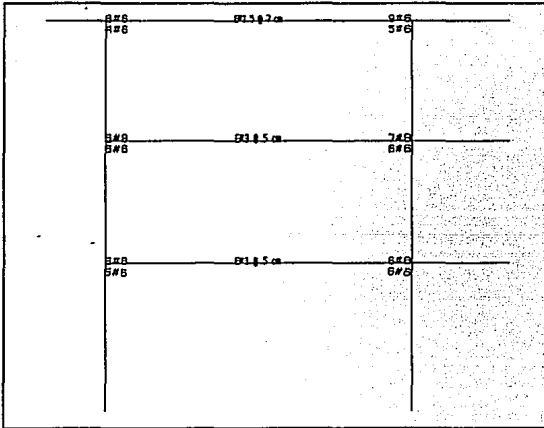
Armados en las vigas del eje 2, modelo 1 (Q=4)
